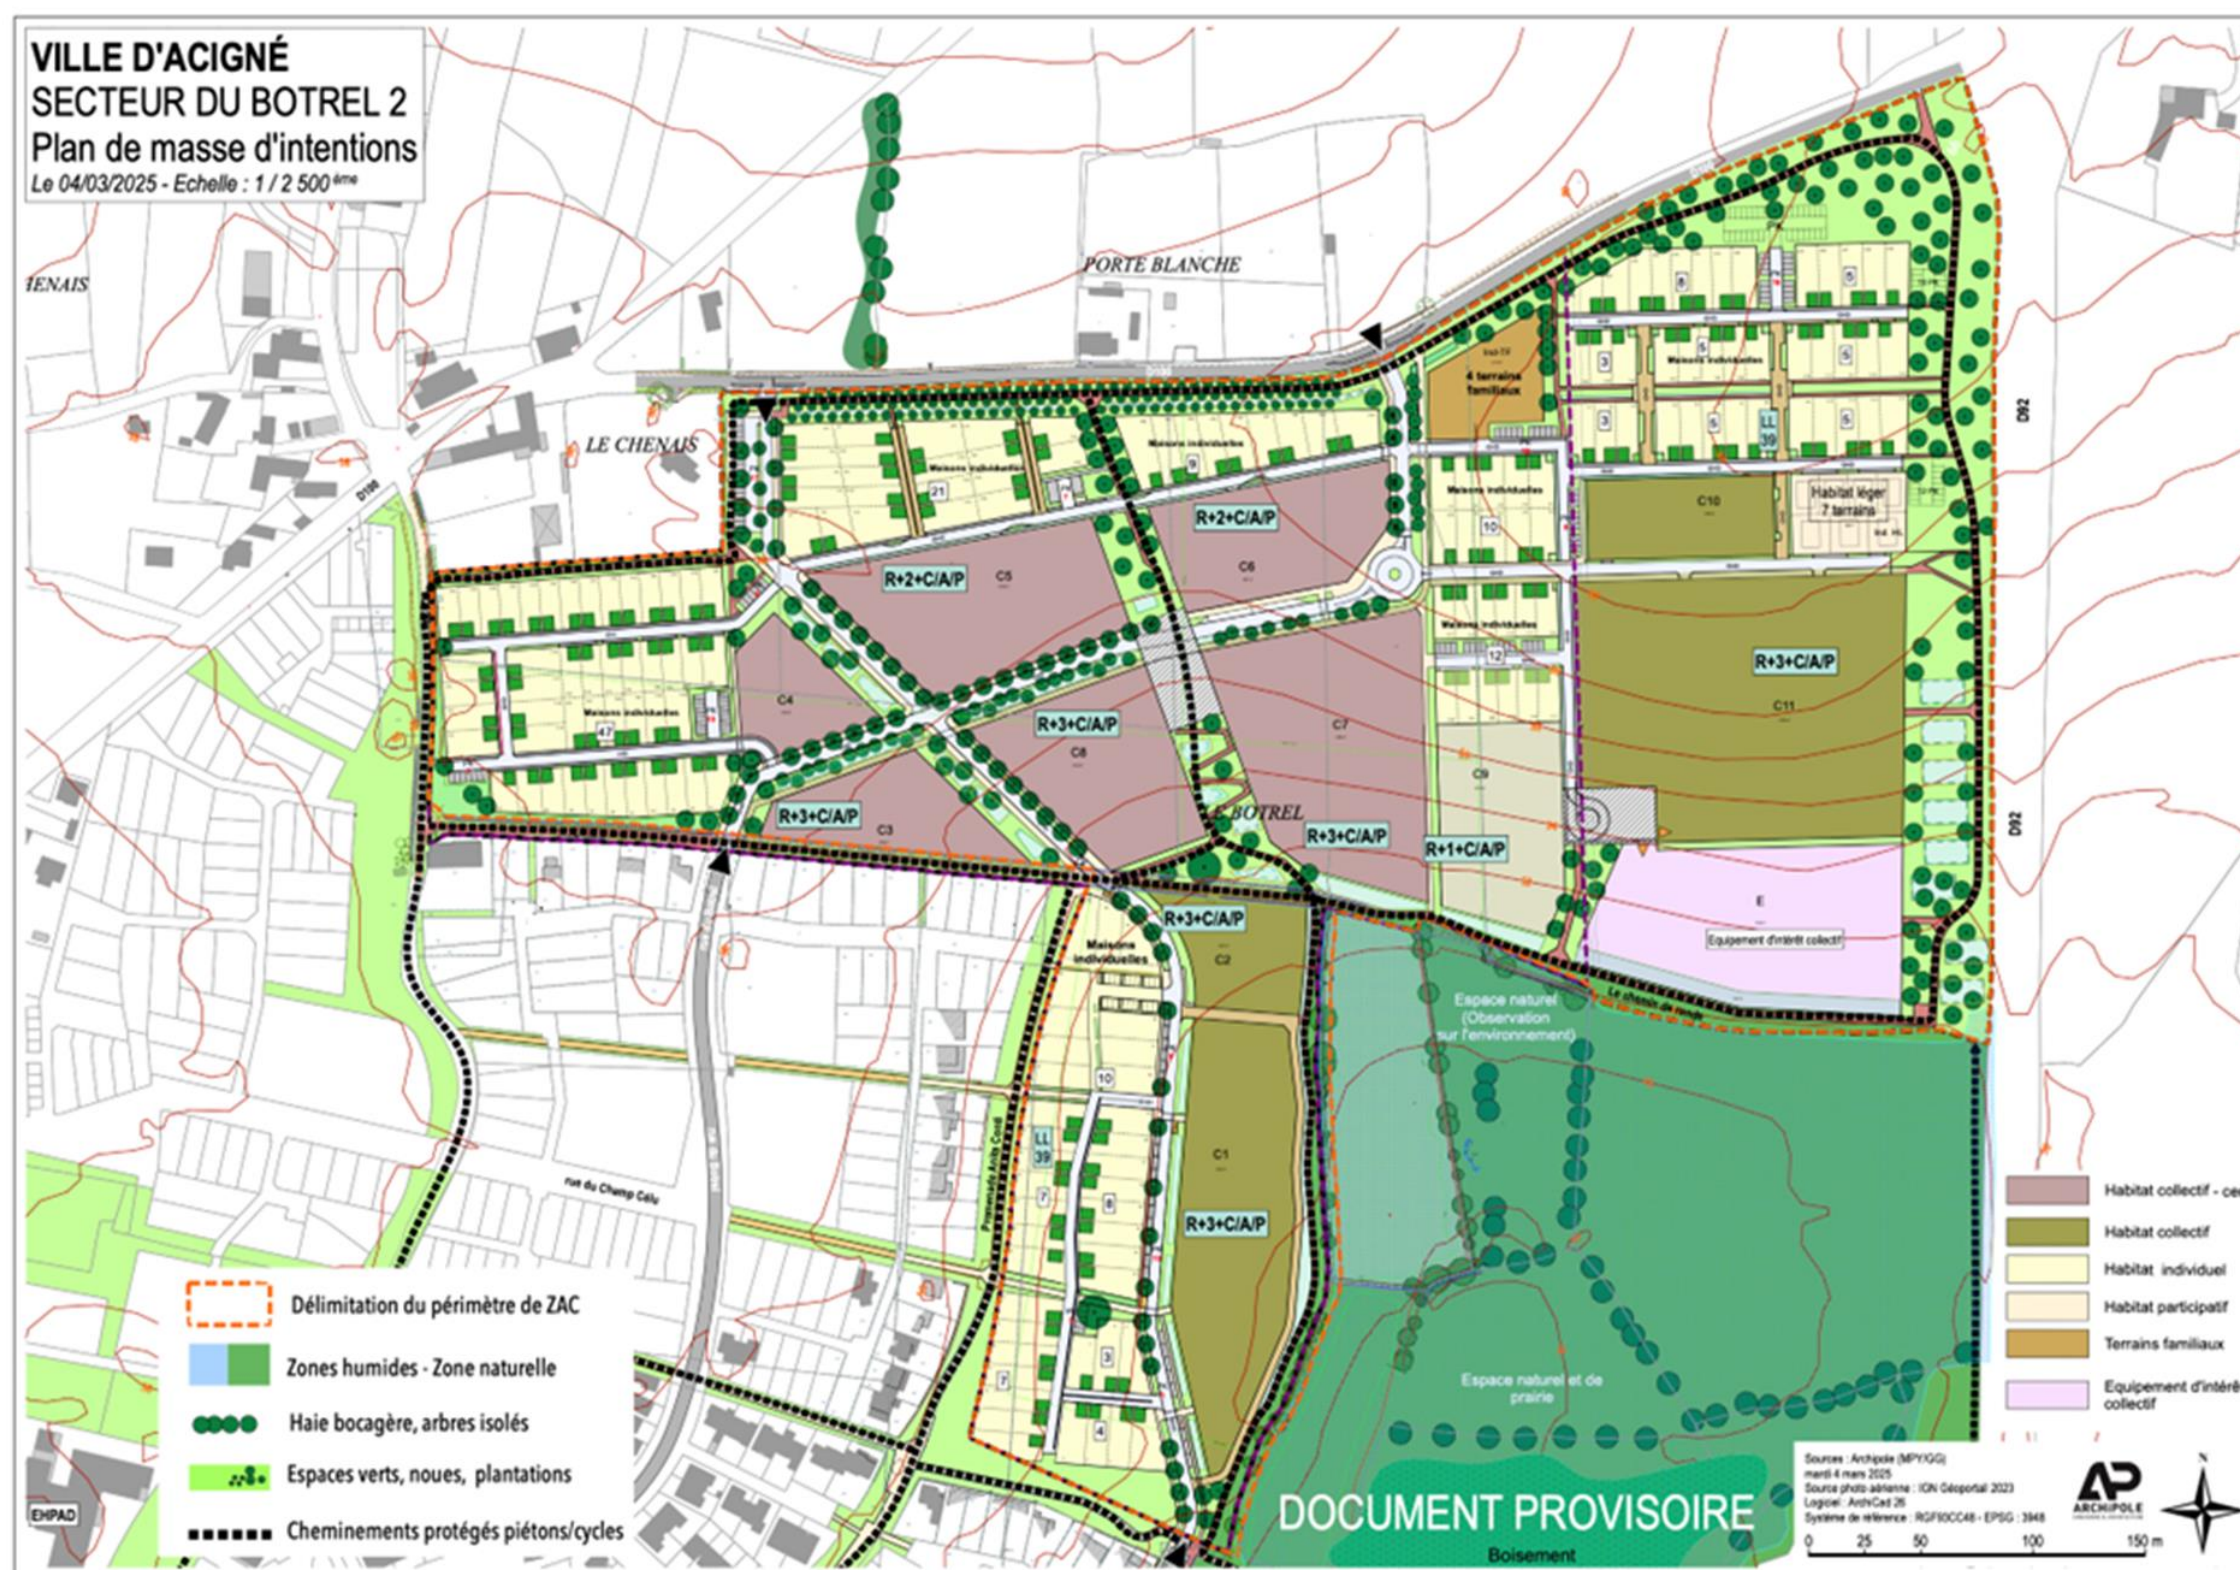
Plan de masse d'intentions – Scénario retenu (Source : ARCHIPOLE, LA PLAGE – Mars 2025)
